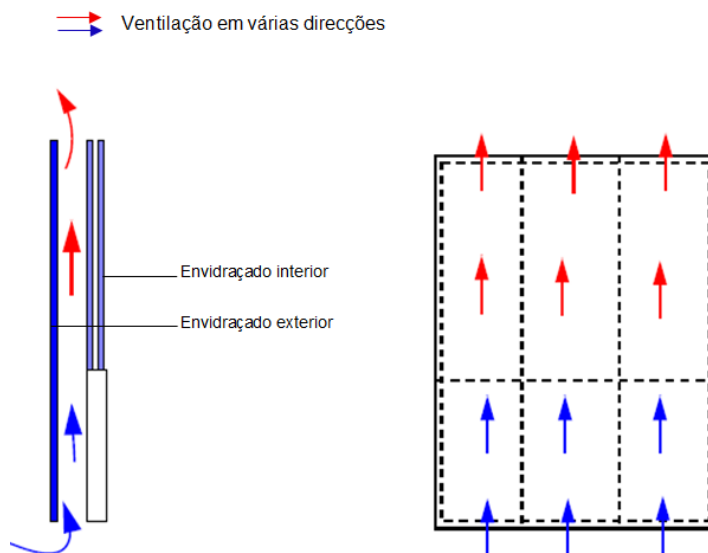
Geometria e esquema geral de ventilação de uma fachada do tipo “Multi-Piso” (vista frontal e corte em perfil) (adaptado de Faggembau, 2006).
